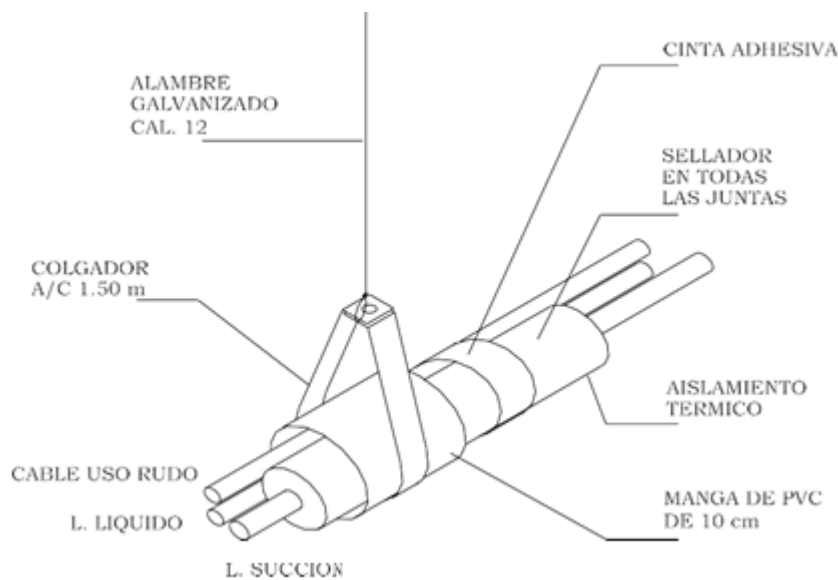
Detalle de soporte de tuberías de gas REF.
